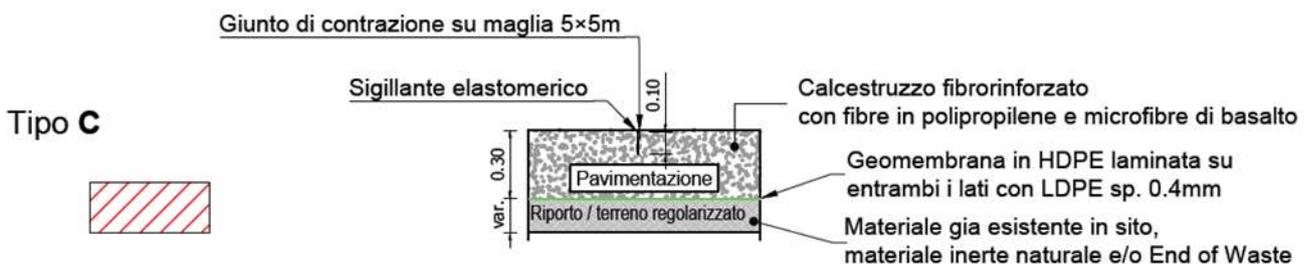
Particolare del pacchetto di pavimentazione di tipo C
